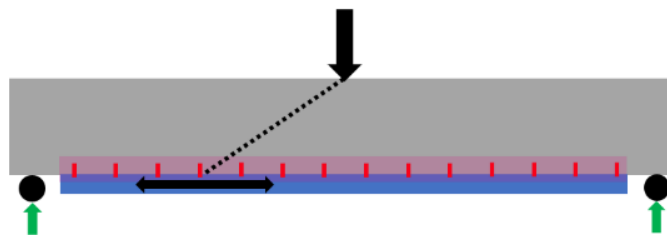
Nueva sección sin apoyos y simplemente conectada en paramento inferior.
